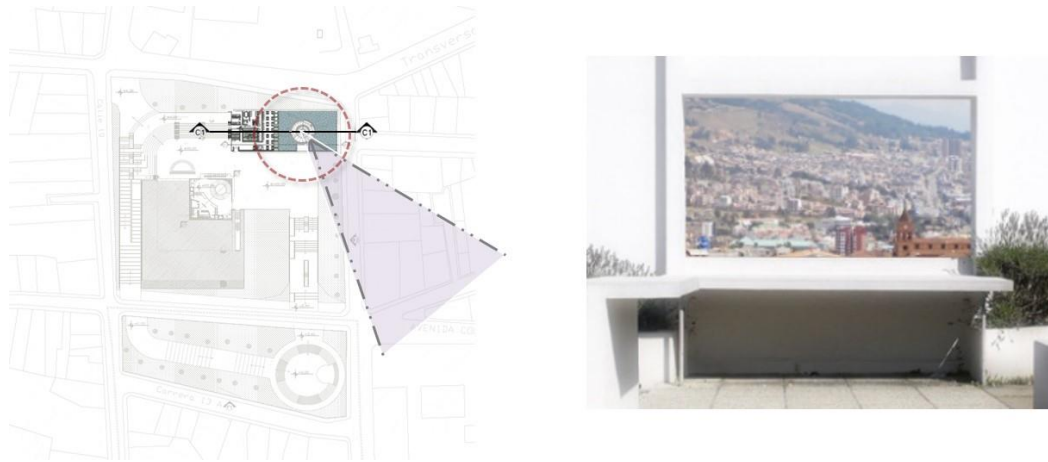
Culminación. Detalle núcleo del restaurante.
